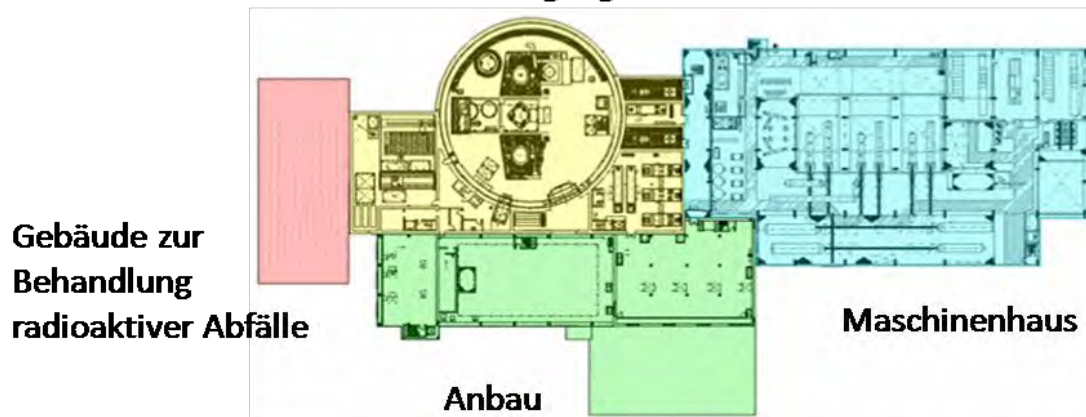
AP-1000, Lageplan, nur das Containment ist gegen EVA geschützt
